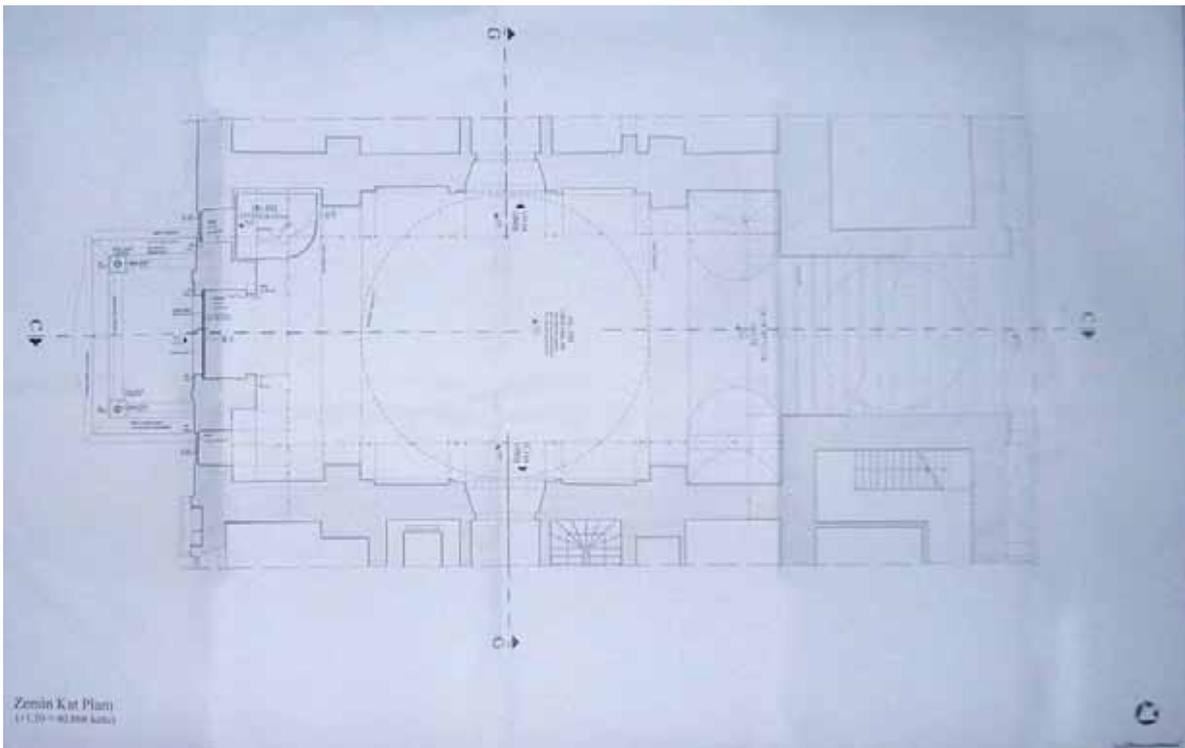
Restaurierungsprojekt des überkuppelten Eingangsbereichs, Grundriss-EG, 2008
